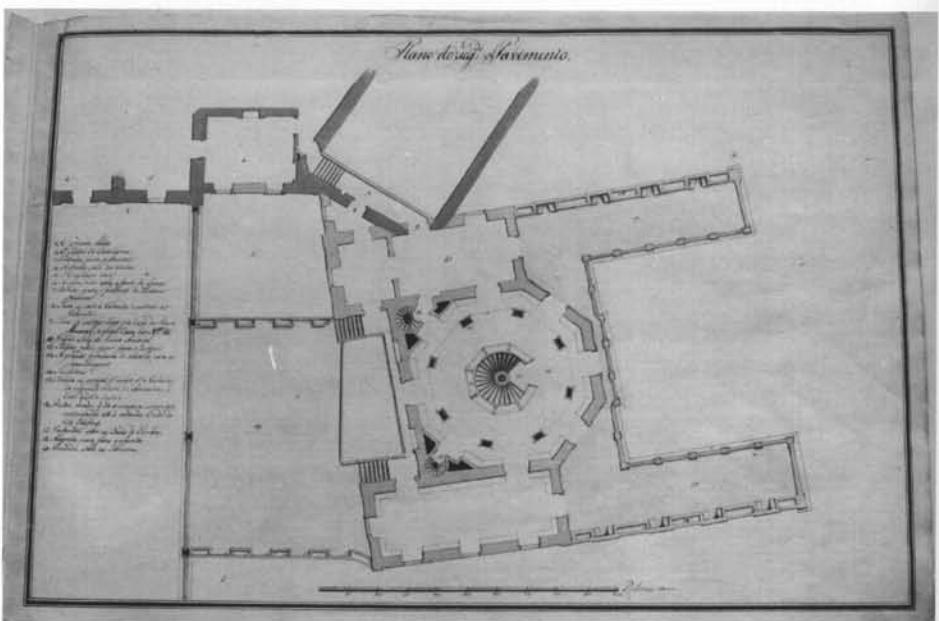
1.º Projecto: "3. Plano do seg.º Pavimento".
